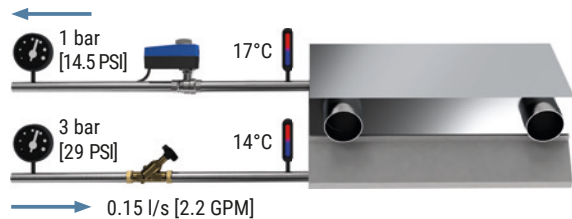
Kühlbalken mit einem druckabhängigen Ventil.
